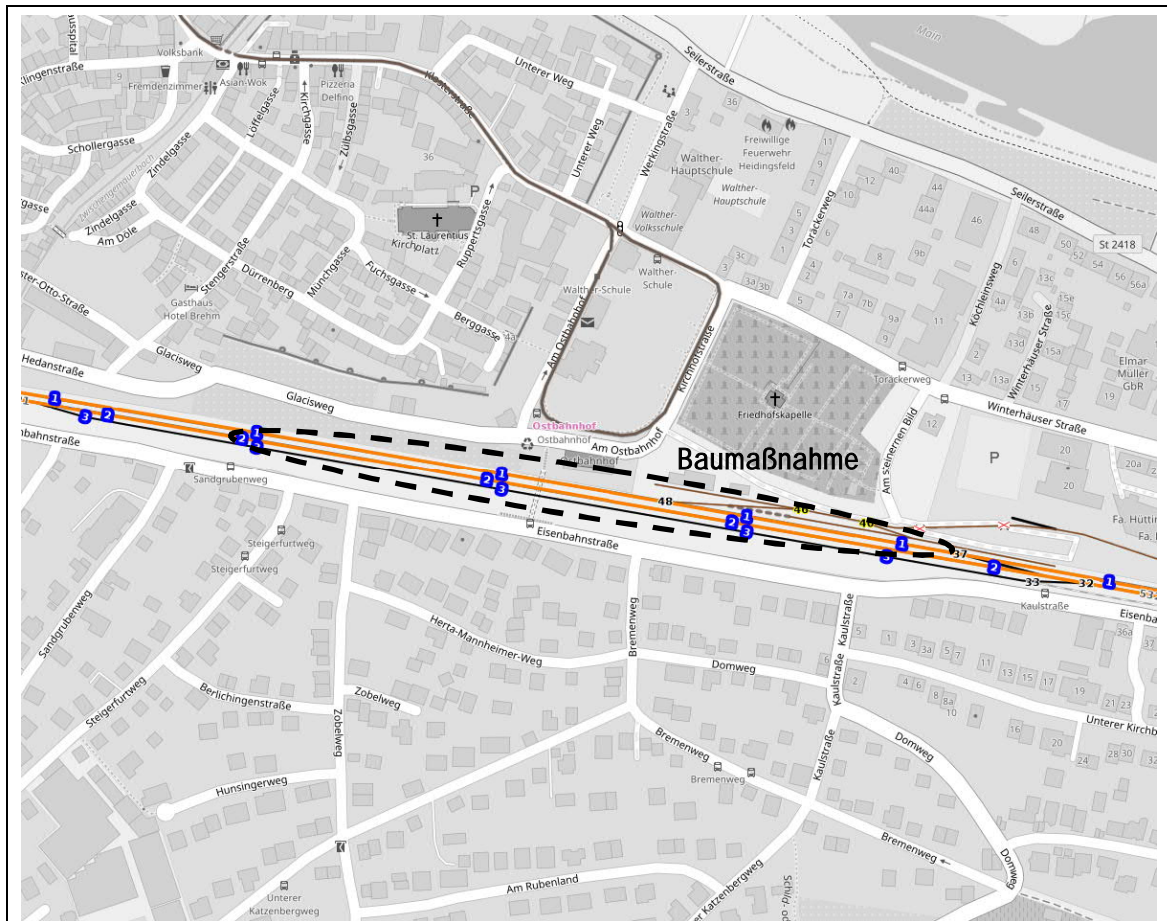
Übersichtslageplan mit Darstellung zur Lage der Baumaßnahme (Quelle: BayernAtlas)
